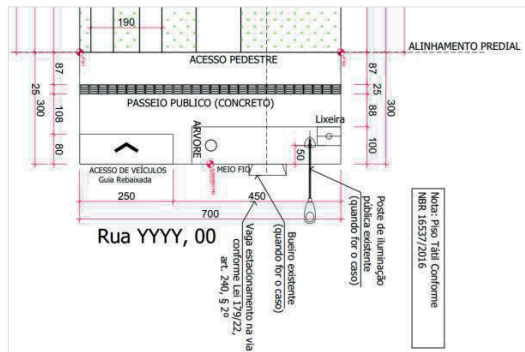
Detalhamento da calçada de um lote típico. Fonte: Projeto Arquitetônico.
